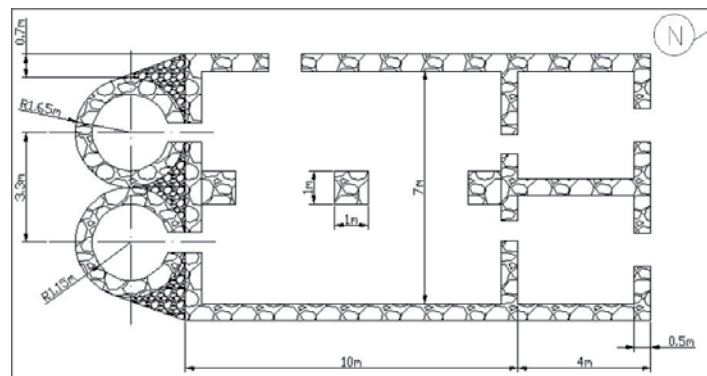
Planta de la instalación más lejana a las canteras (hornos, era y almacenes). La simetría y exactitud propias de un plano no se corresponden completamente con las desviaciones aleatorias de la arquitectura real, por su erección artesanal.
